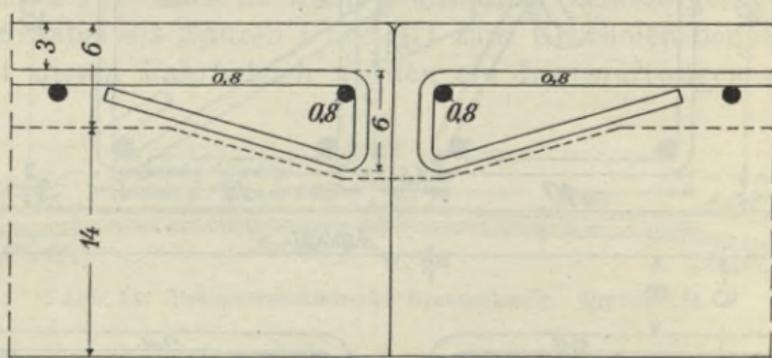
Betonversuchsstrecke Braunschweig. Querfuge.
